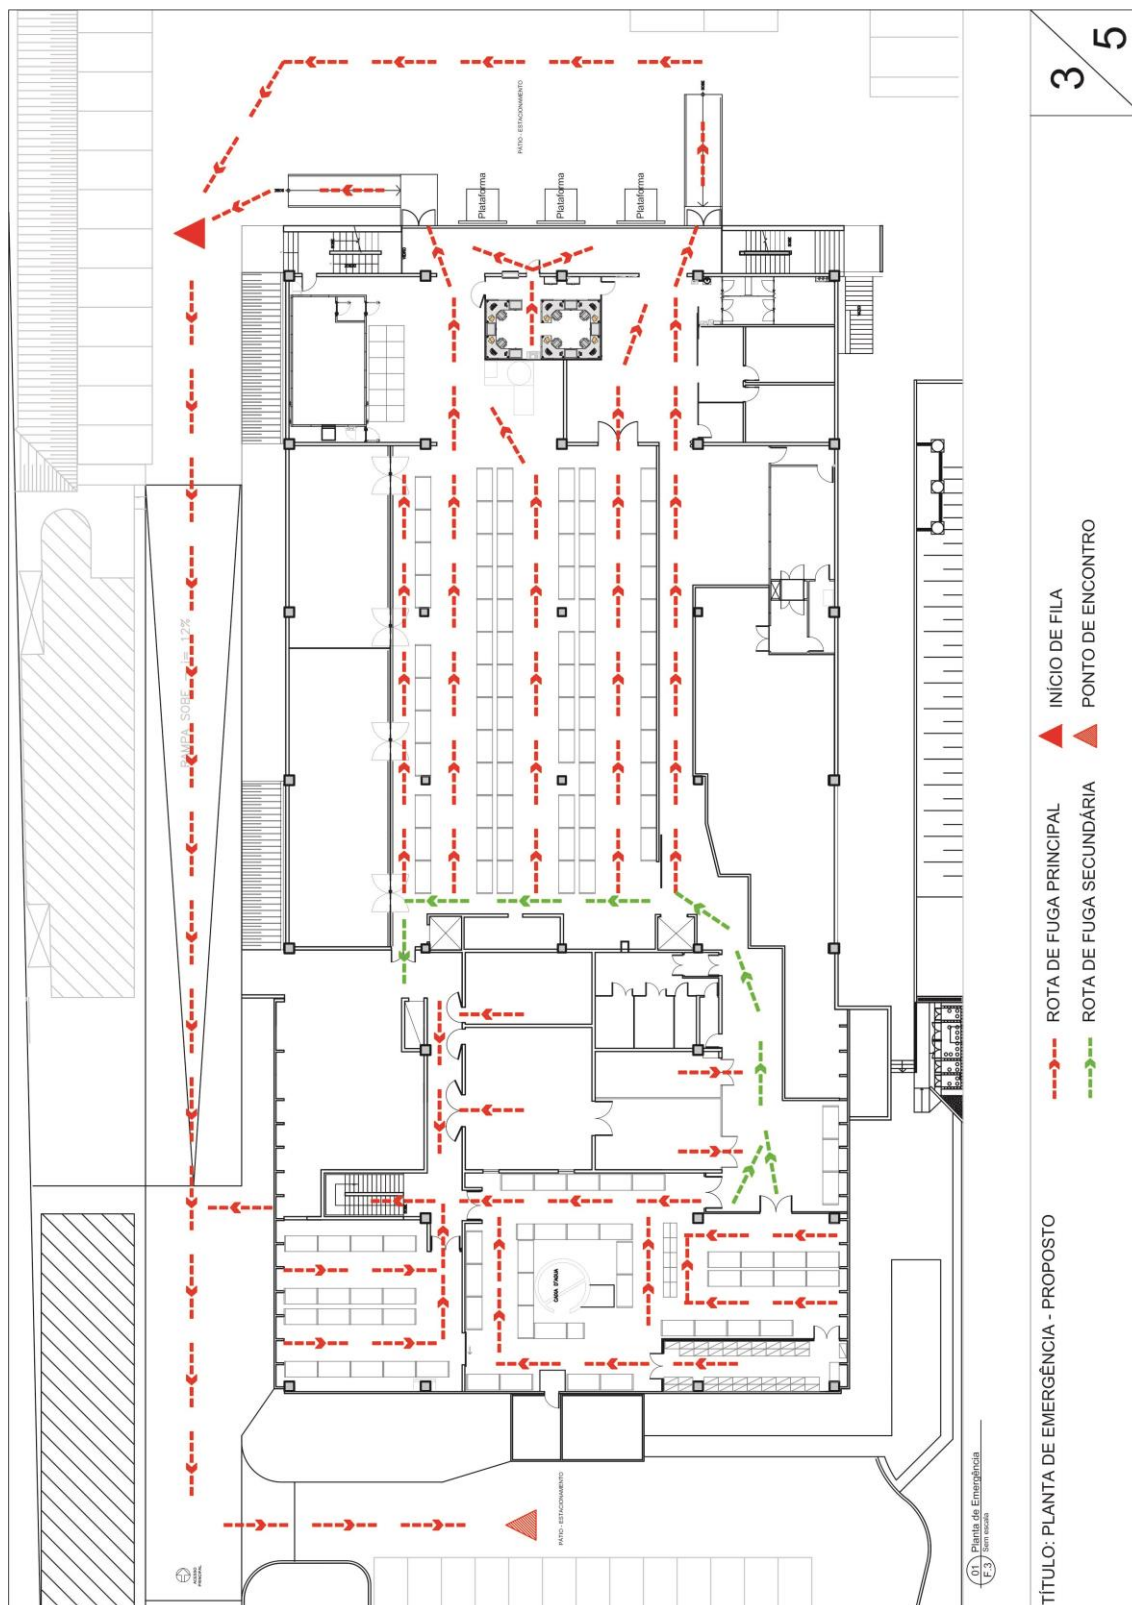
Planta de emergência - proposta, São Paulo - SP.
